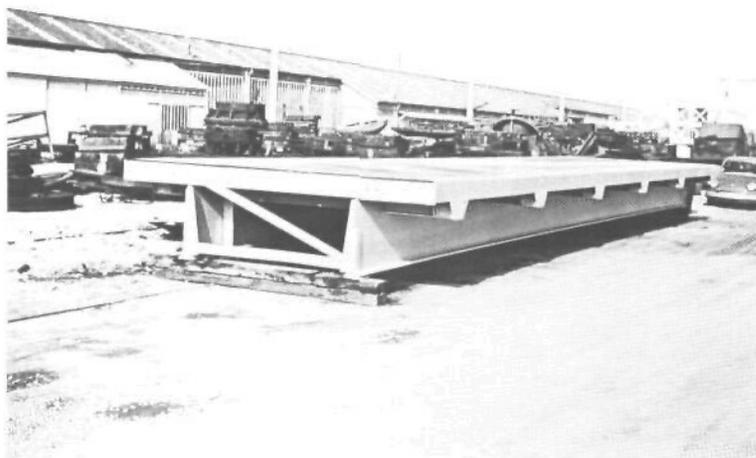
Assemblage de poutre en I. Les poutres sont entretoisées provisoirement.
